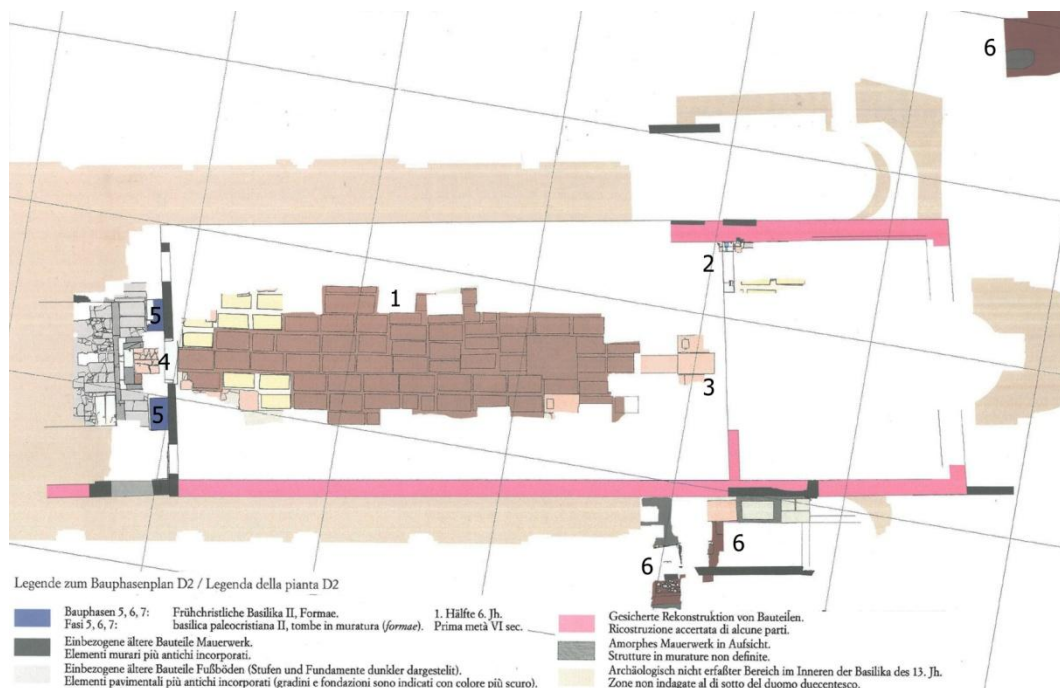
Grundriss Basilika II. Rasterung entspricht 10 x 10 m.
